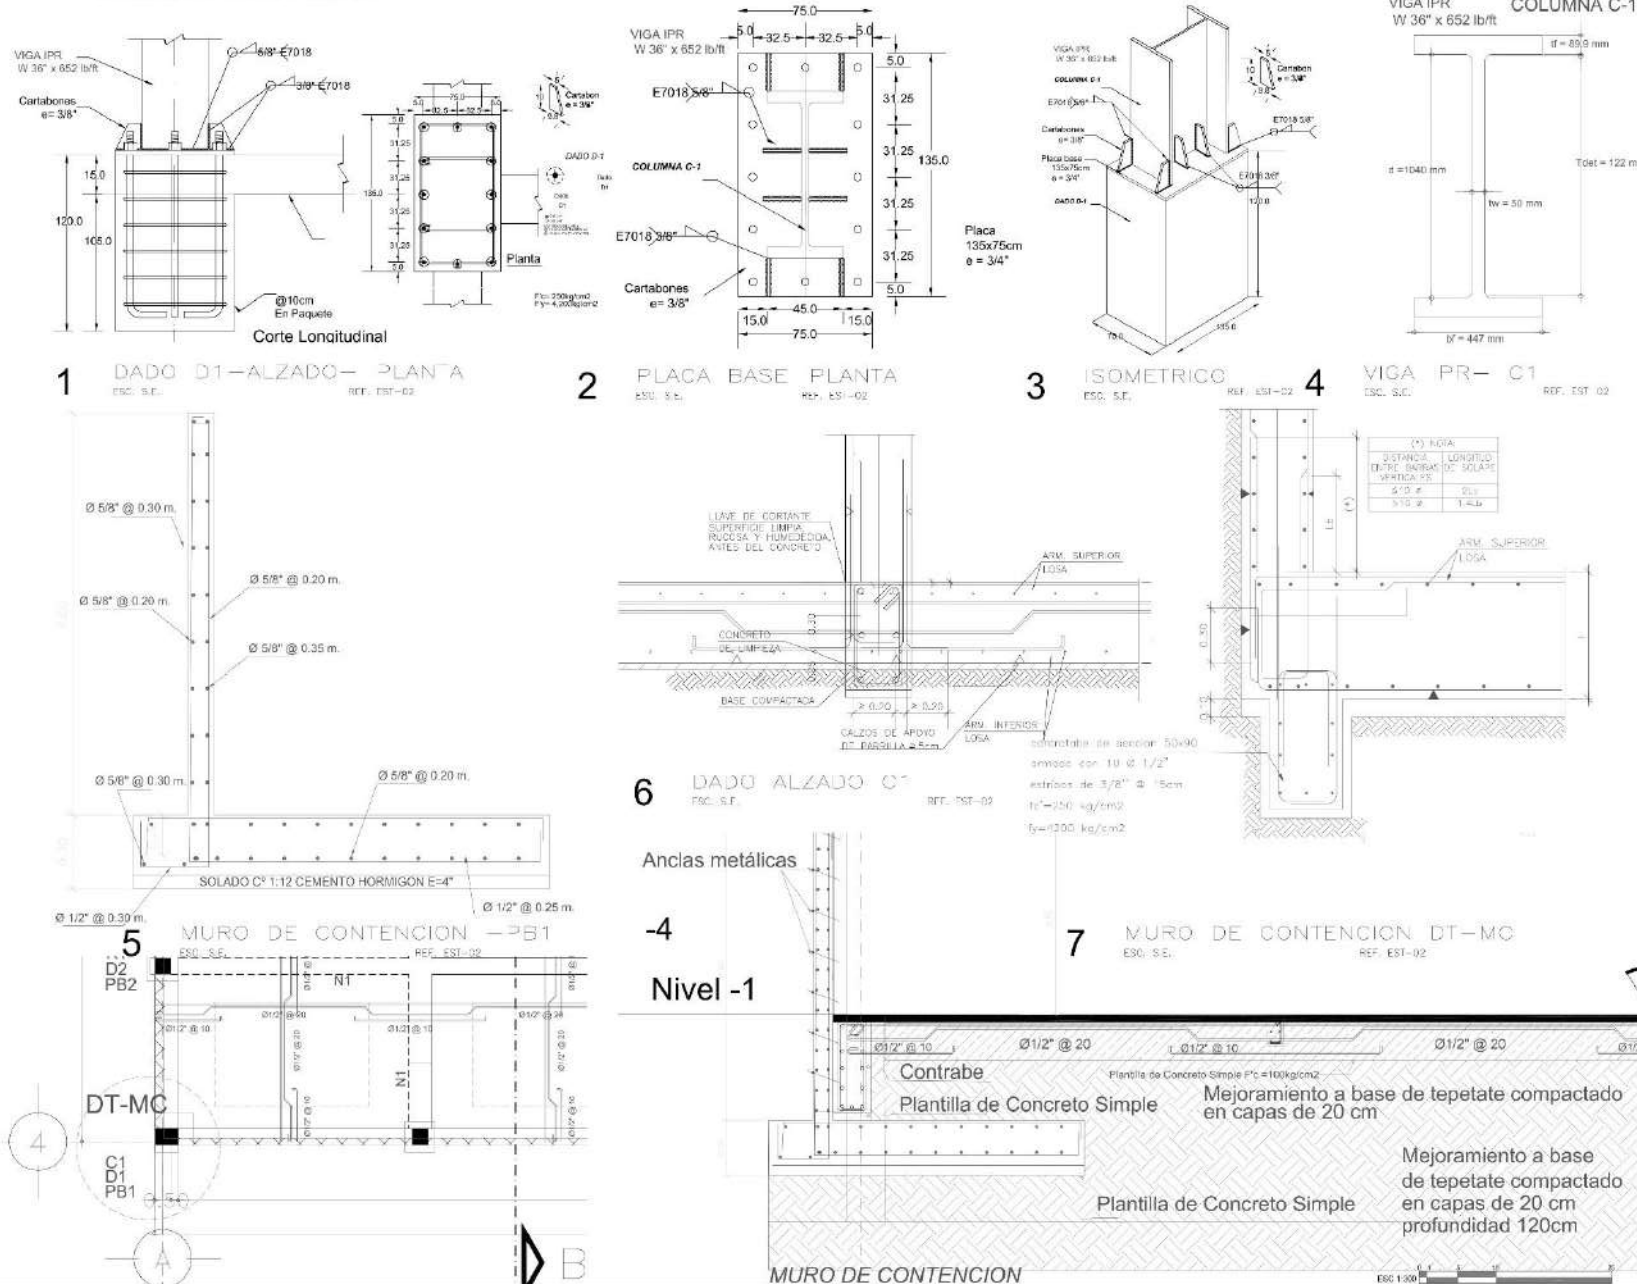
,97,98,99,100 PLANOS ESTRUCTURALES
